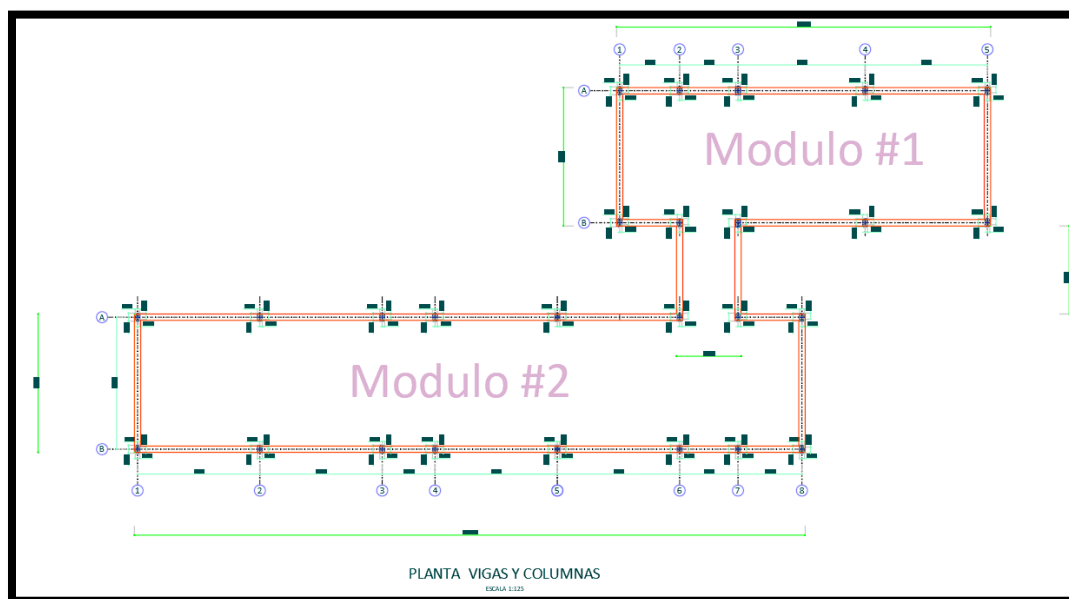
vista en plana de los módulos. Fuente: Diseño Estructural.
